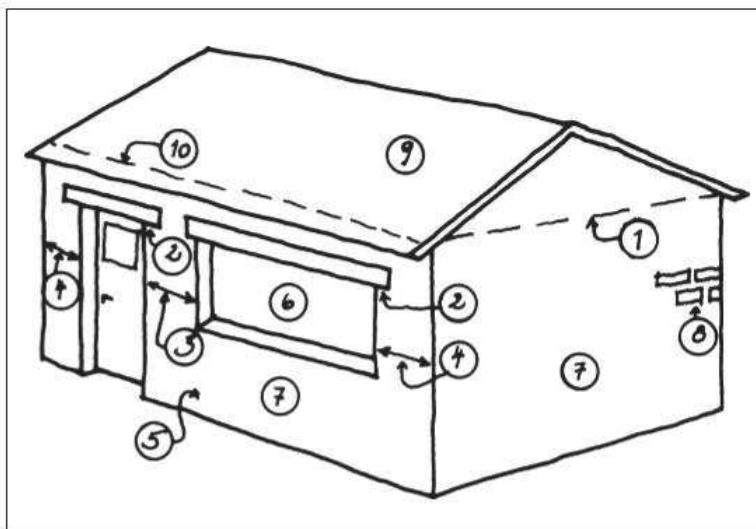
Errores al construir una vivienda rectangular con adobe. Fuente: Minke (2005b).
